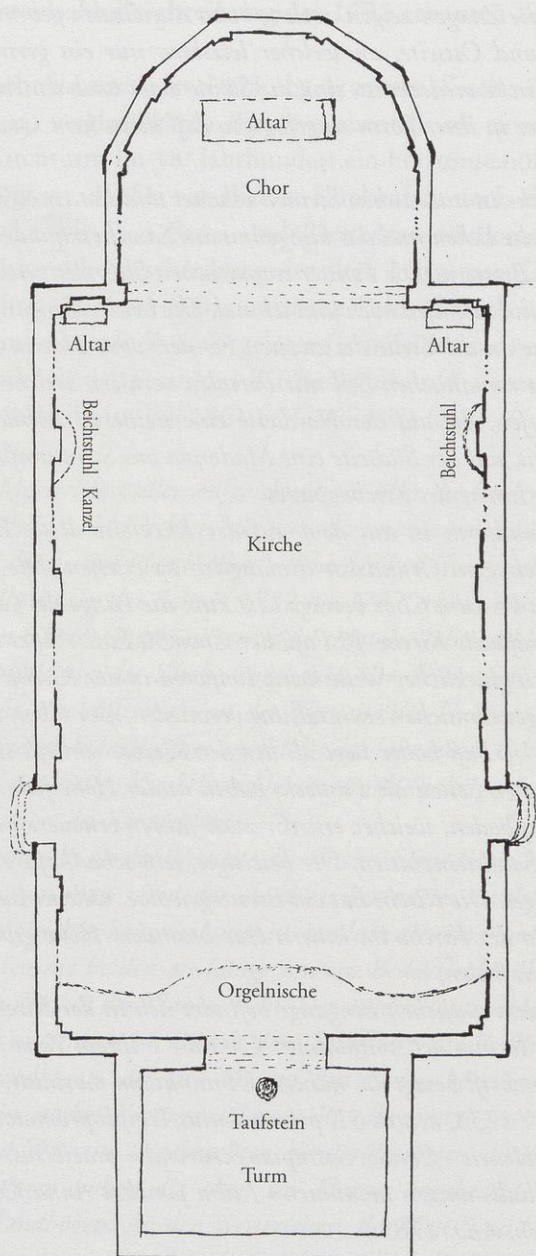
Grundriß der 1732–1737 erbauten Pfarrkirche St. Cäcilia zu Harsum
